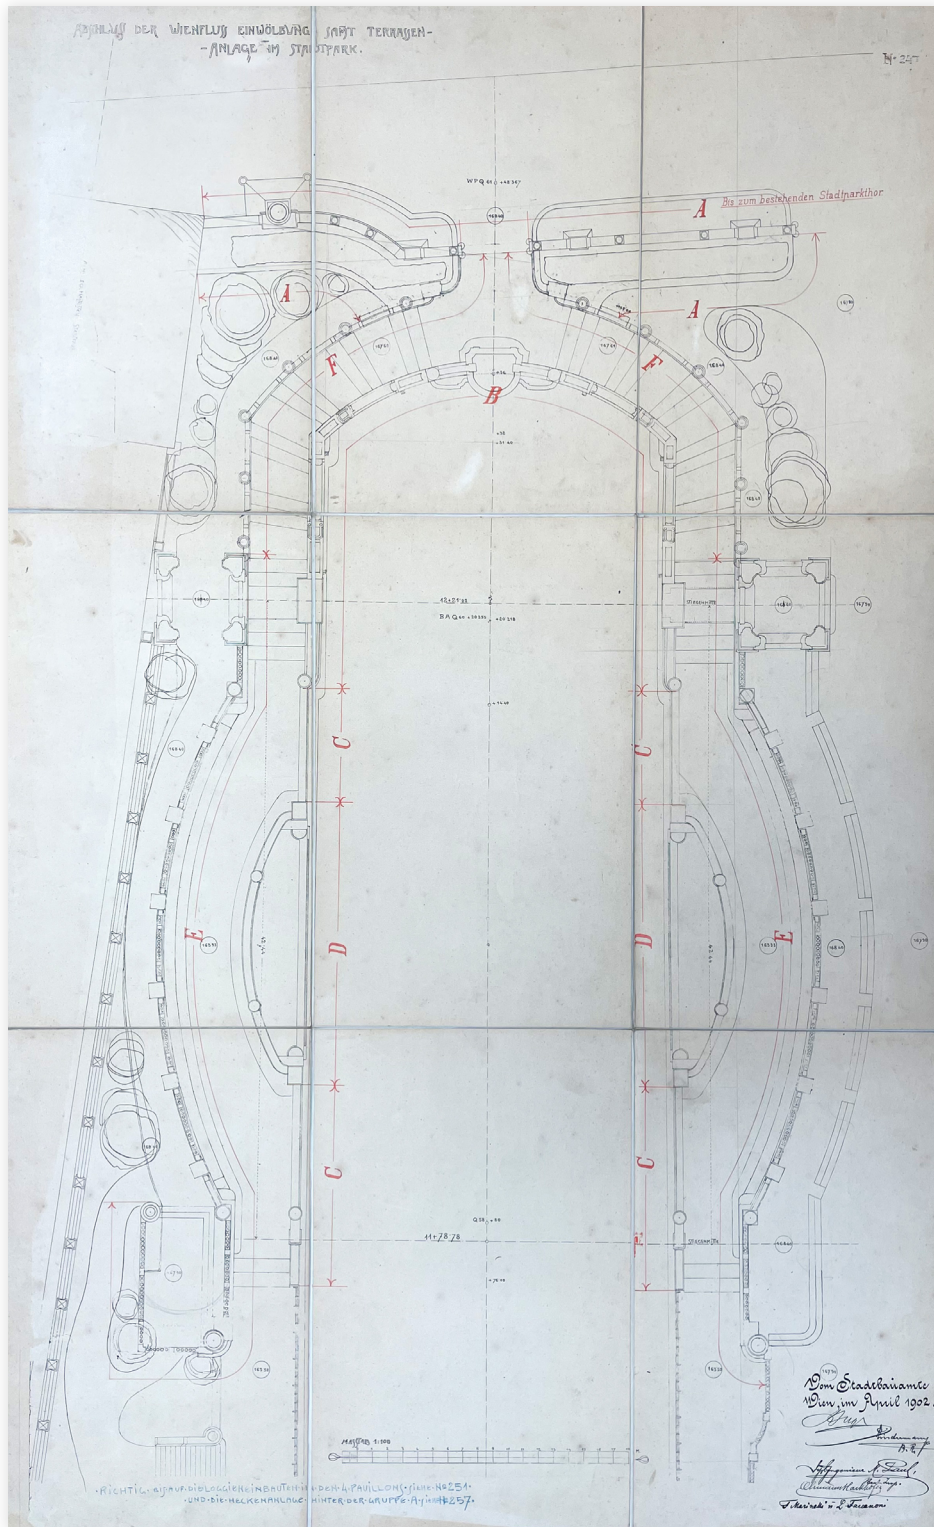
Wiener Stadtbauamt: Portalanlage, Grundriss, Blatt No. 247, 1902.
